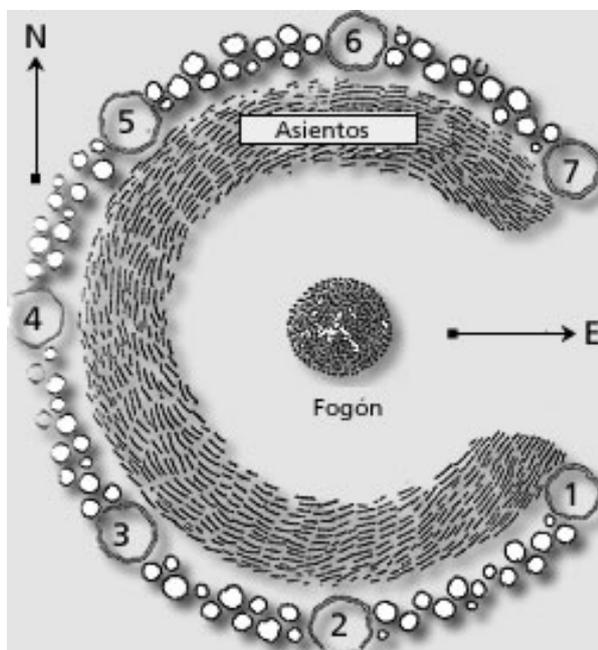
Plano de la Choza Ceremonial con los siete pilares principales.
